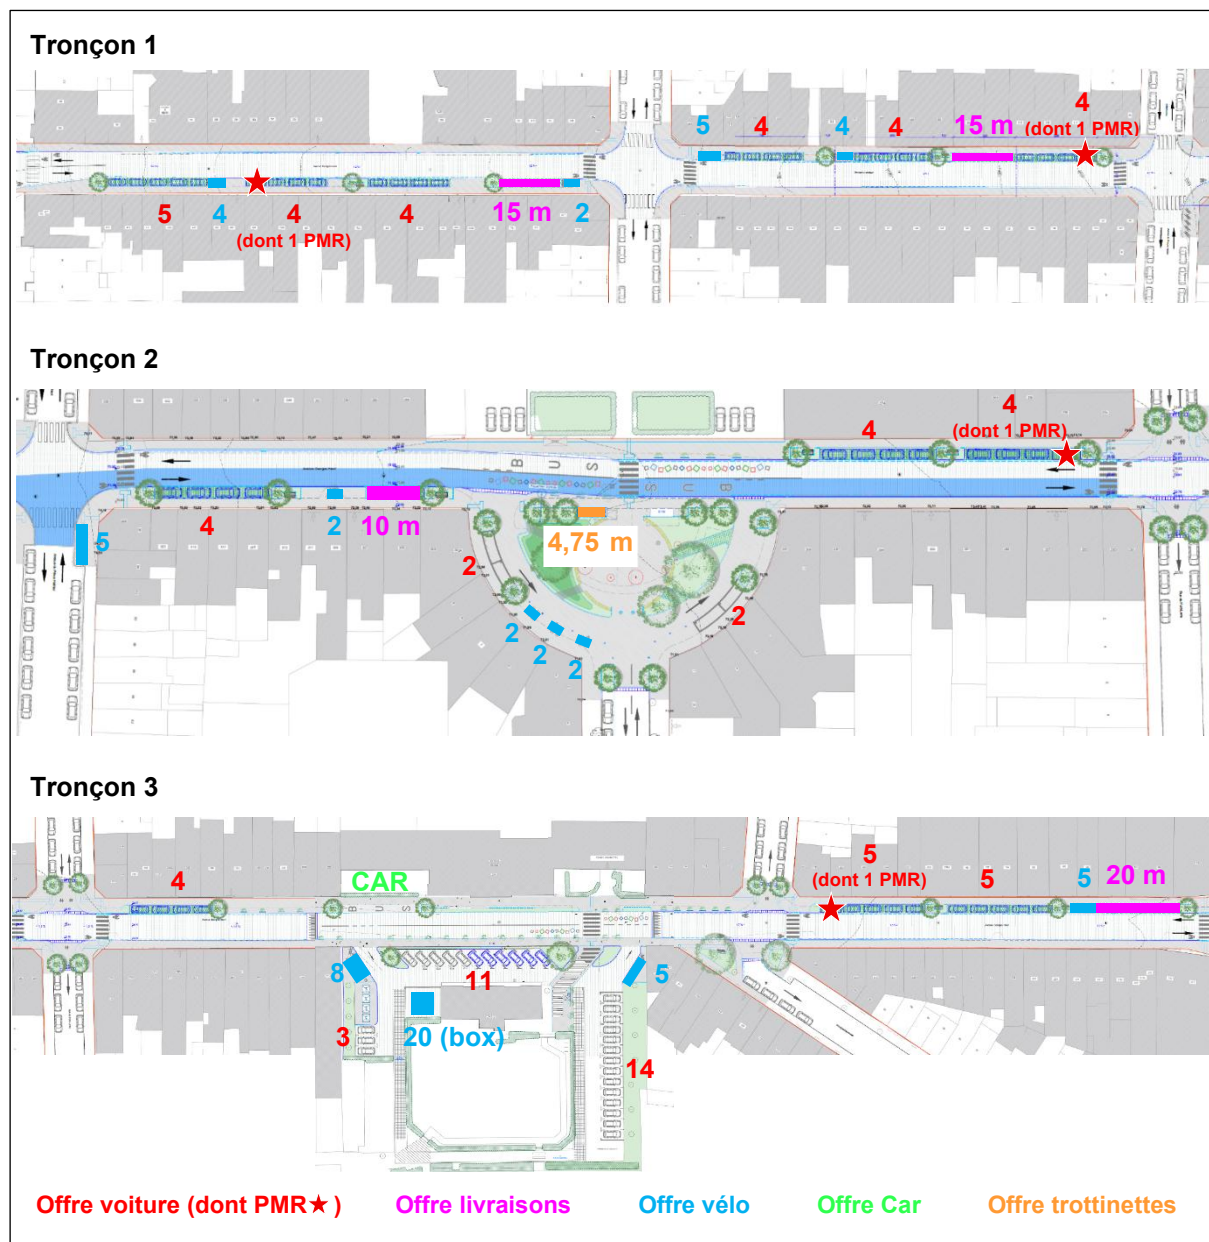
Organisation projetée du stationnement par type de places (fonds de plan : Demandeur)
